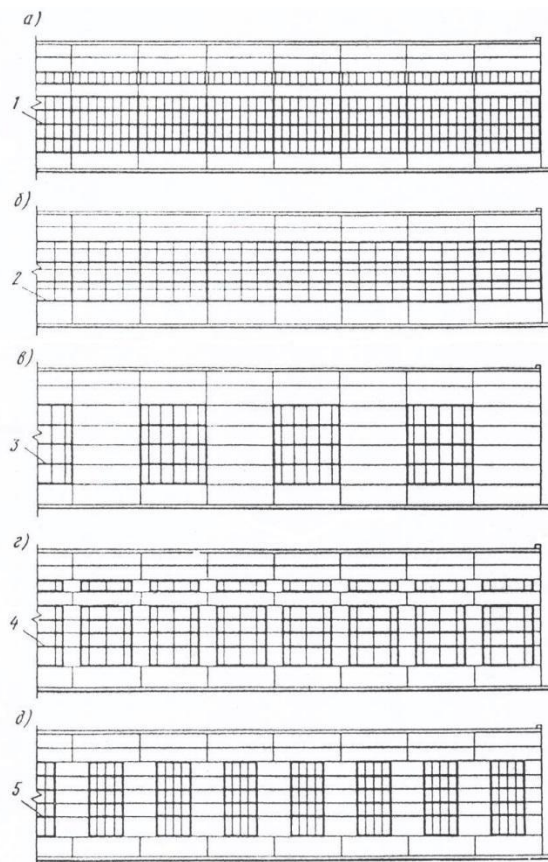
Схемы раскладки панелей в стенах одноэтажных зданий:
